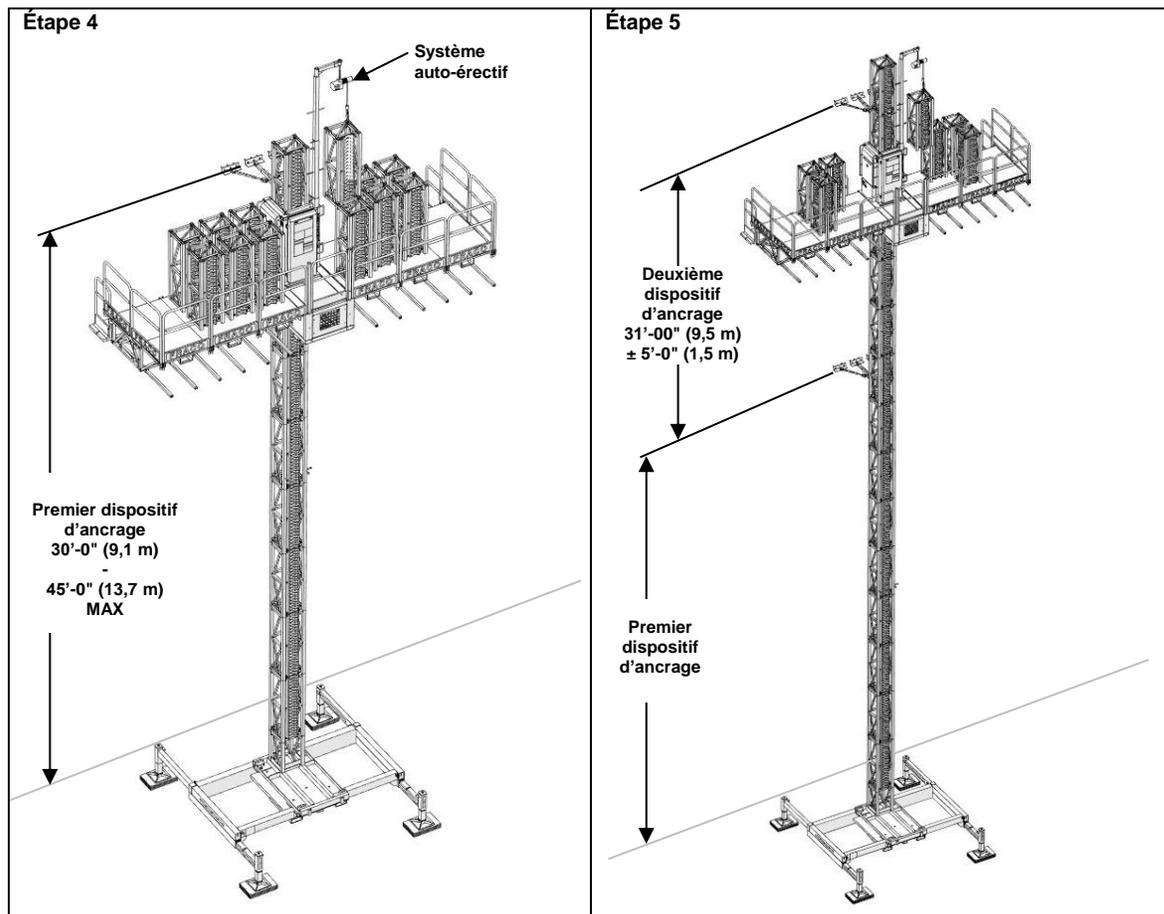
Installation mâts et ancrages sur base autoportante, auto-érectif (optionnel)
